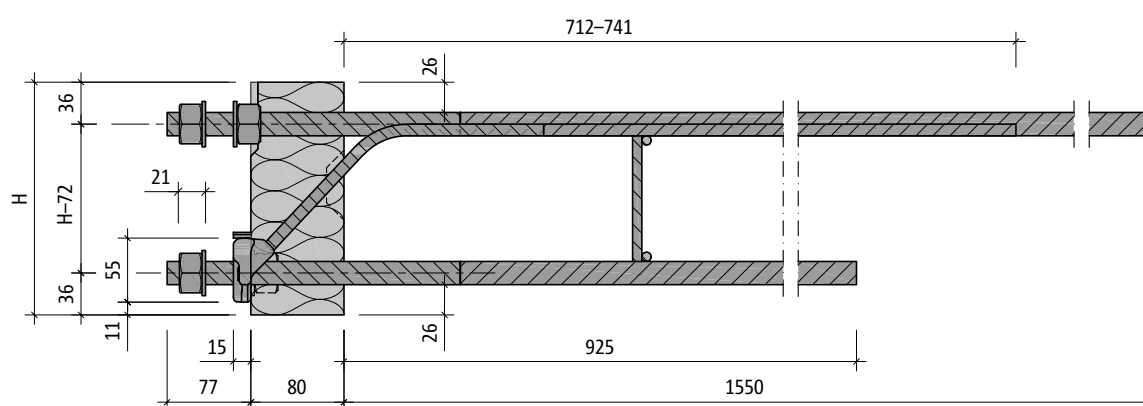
Schöck Isokorb® T type SK-MM2-VV1 : vue en coupe du produit
